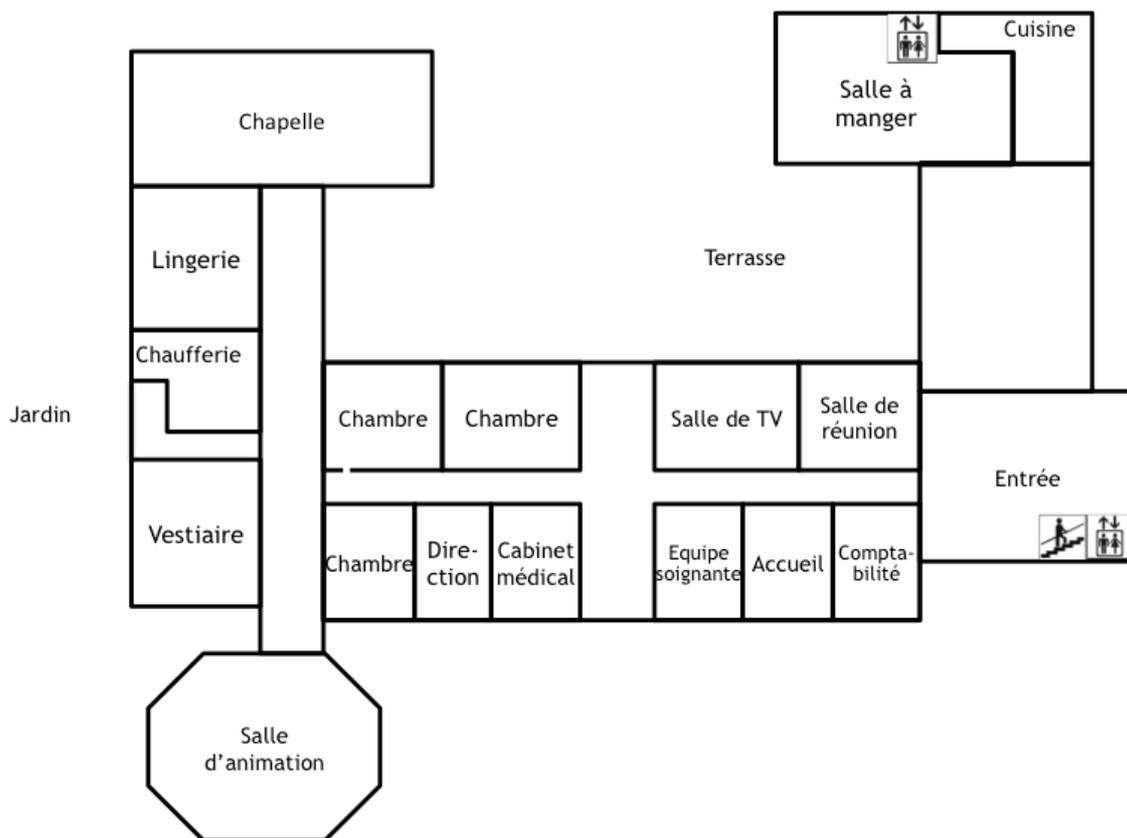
EHPAD Bon Pasteur - Plan du rez-de-chaussée (version V3)
